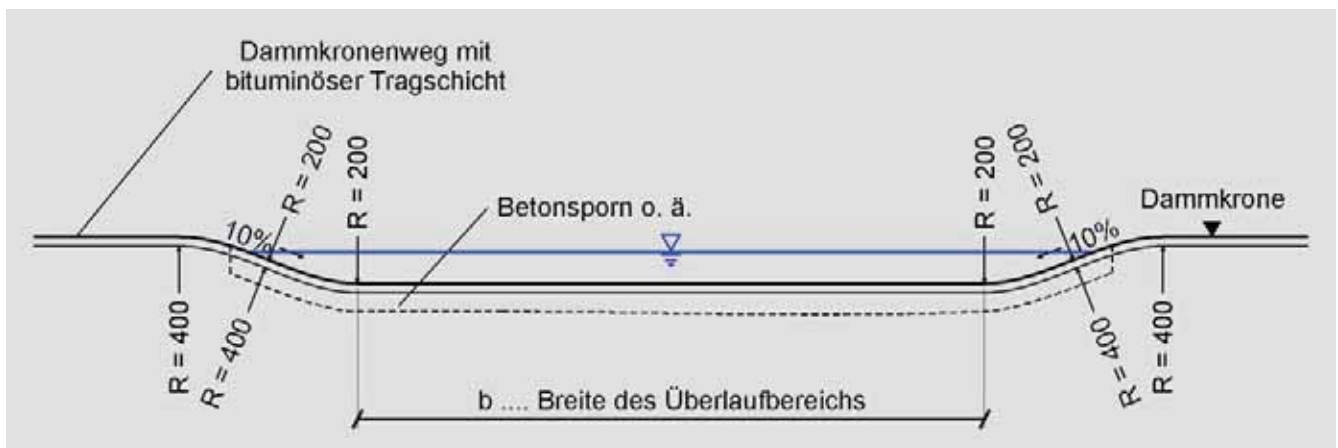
Prinzipskizze einer befahrbaren Dammscharte (Längsschnitt).
